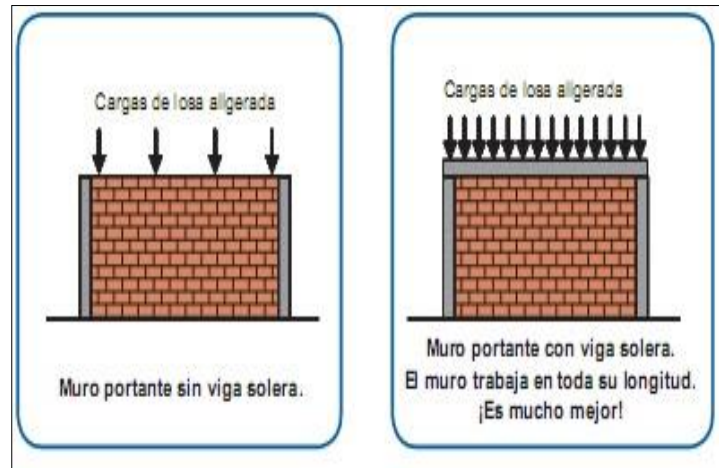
Detalle de muro portante. Fuente: Aceros Arequipa (2016).
